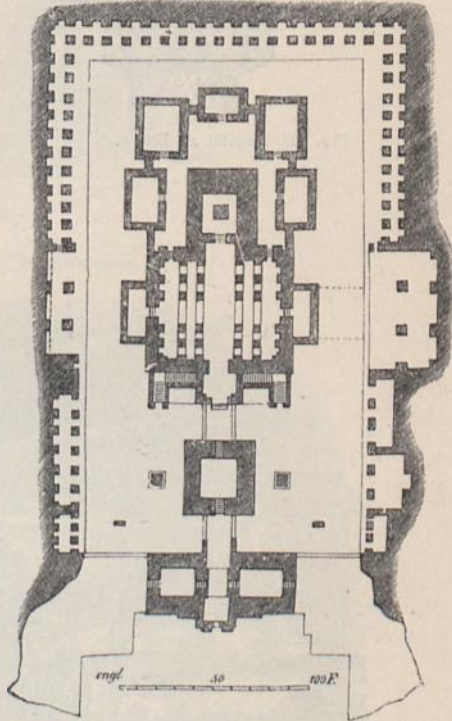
Grundriss der Kailasa-Grotte zu Ellora.
